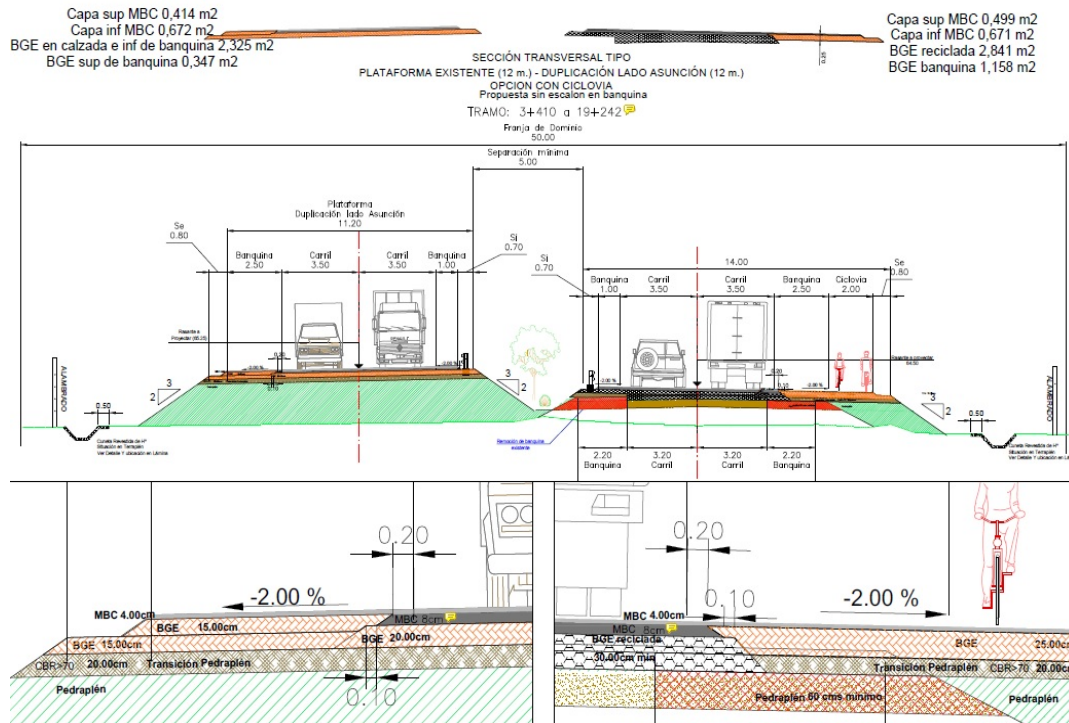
Sección Transversal opción con ciclovia sin escalón en banquina Pr 0+000 – 3+410
